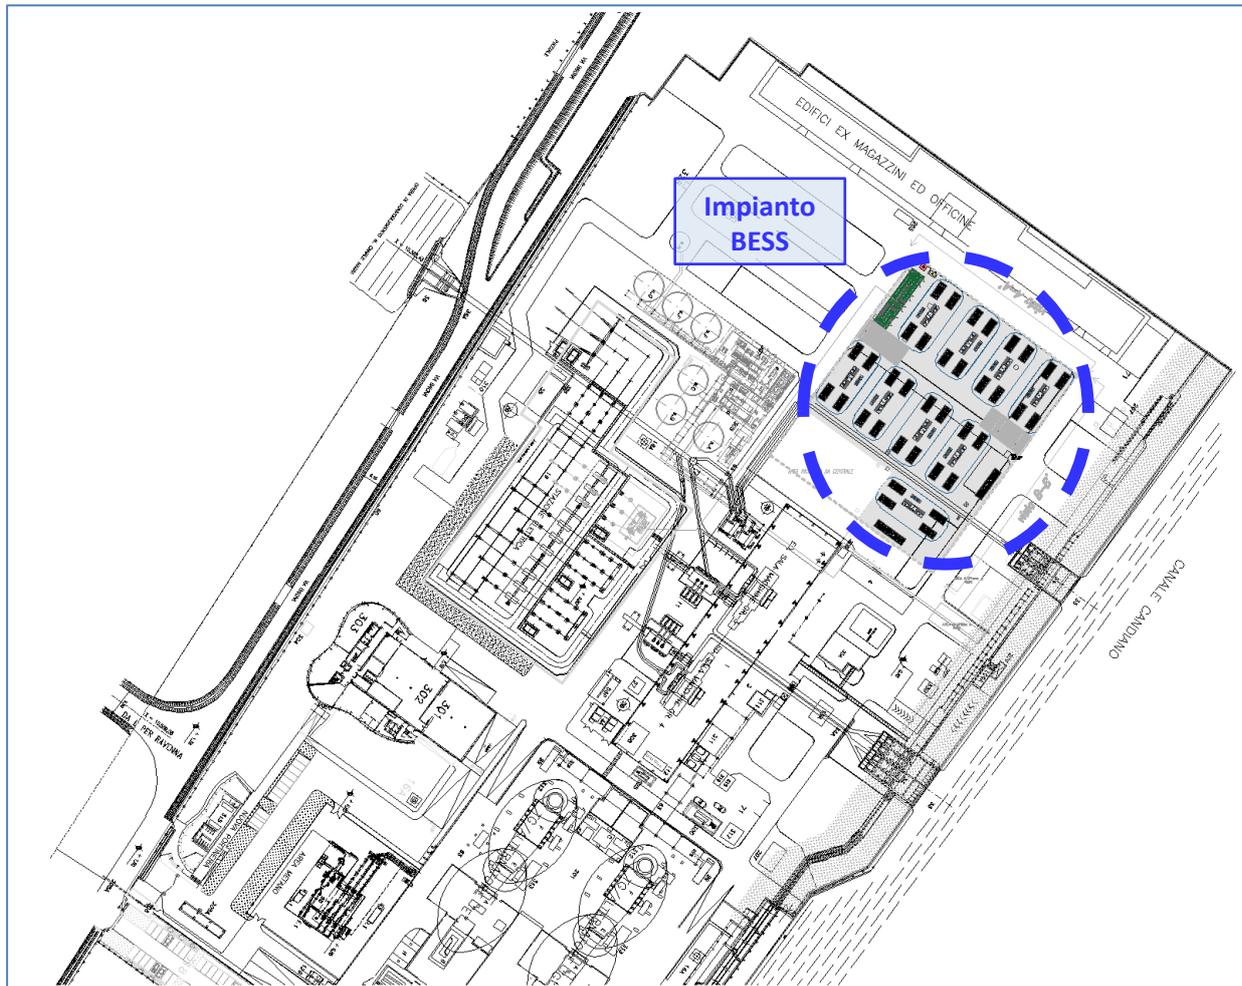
C.le di Porto Corsini – Layout dell’impianto BESS
